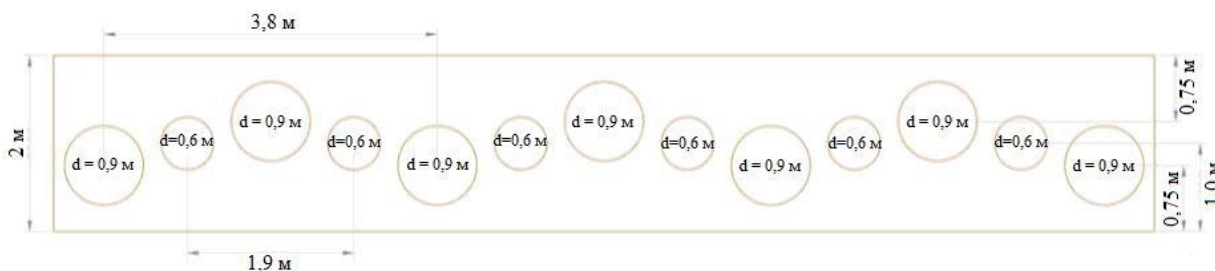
План расположения свай и балки, соединяющей их оголовки
